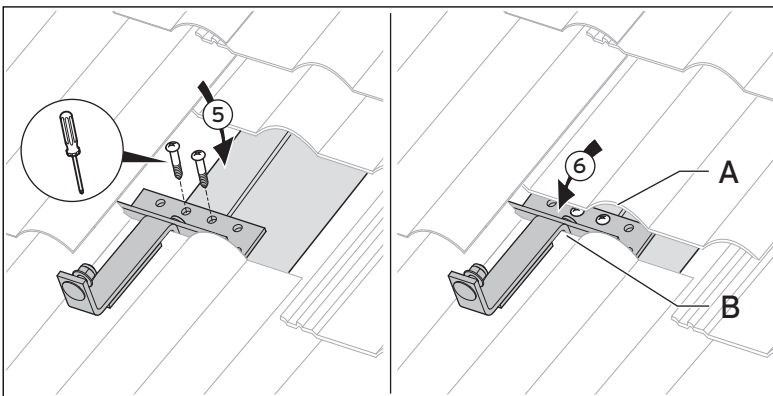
Fissaggio dell'ancoraggio tetto di tipo P al falso puntone
